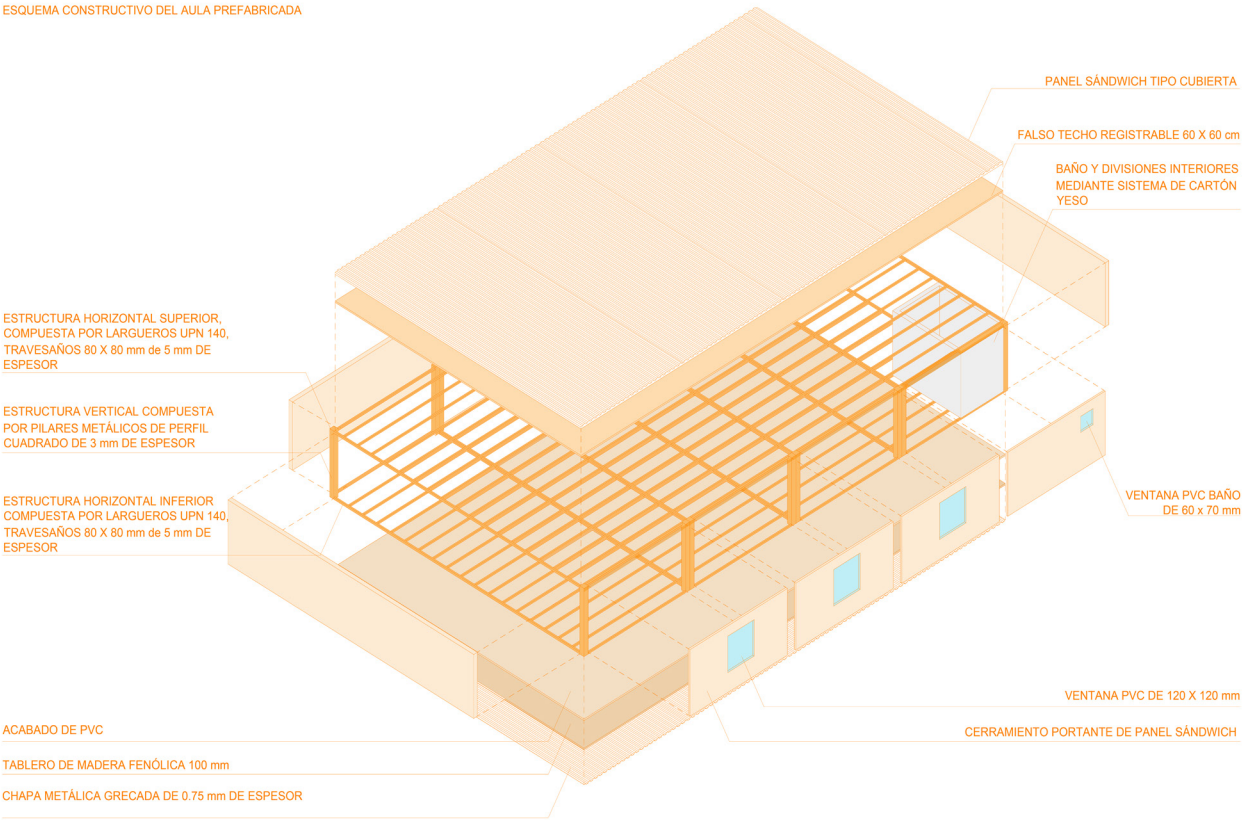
Esquema constructivo de las aulas del colegio de educación infantil temporal “Caracolas” en Utrera (Sevilla). Fuente: Elaboración propia.
